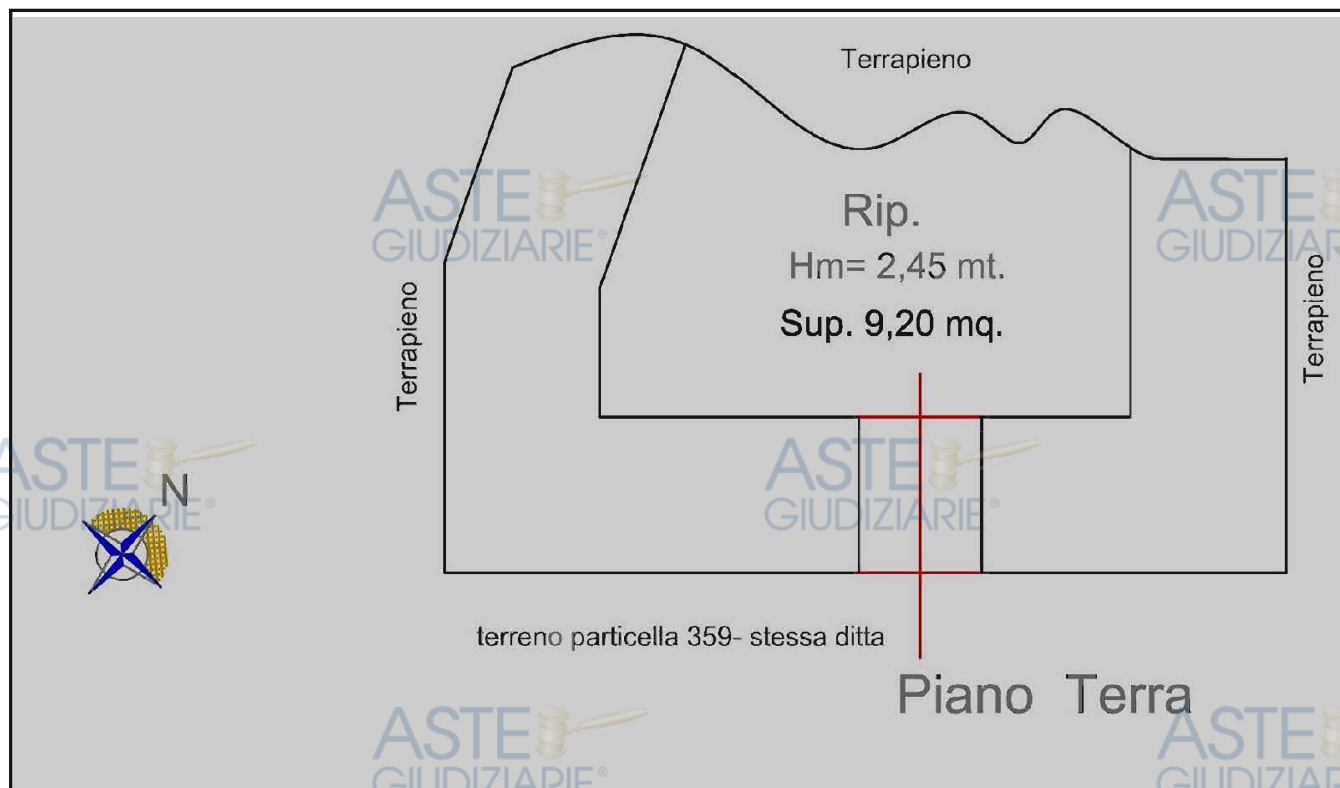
Visualizzazione della planimetria del locale ripostiglio
